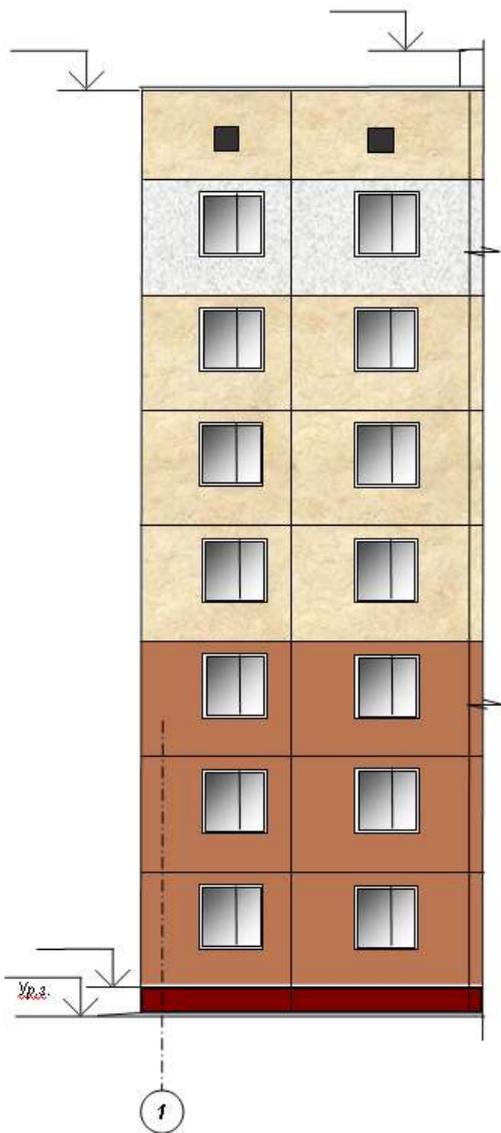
Пример оформления фасада жилого дома со стенами из крупных панелей
